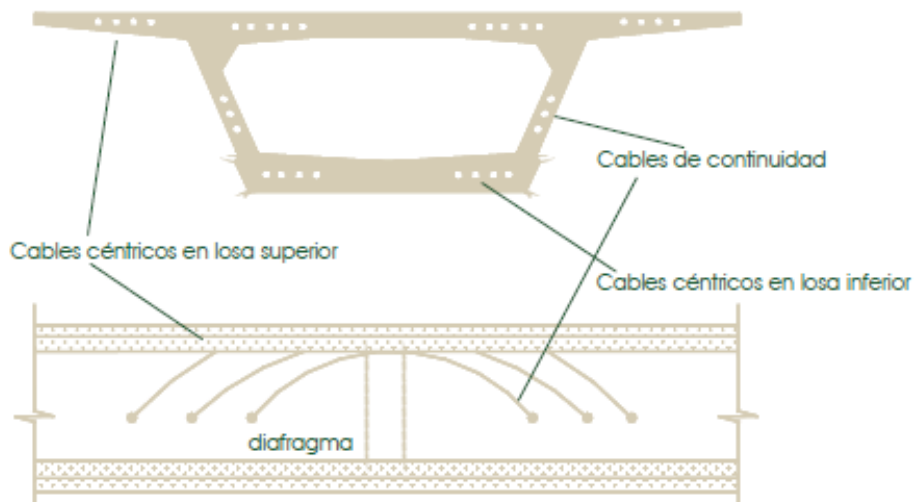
Esquema del pretensado de puentes construidos por empuje. Fuente [11]
